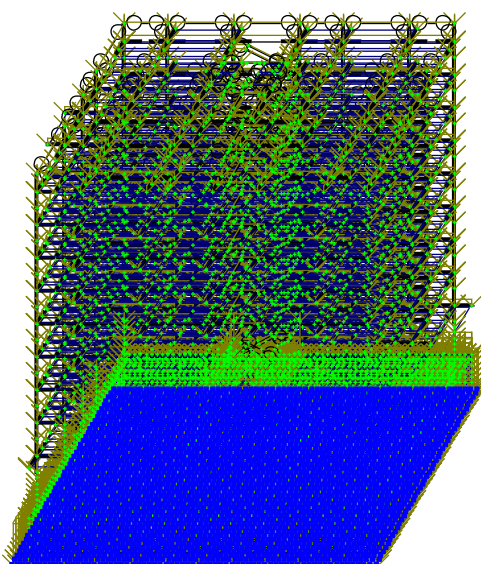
Расчетная схема 9-ти этажного каркасного здания рамной схемы
